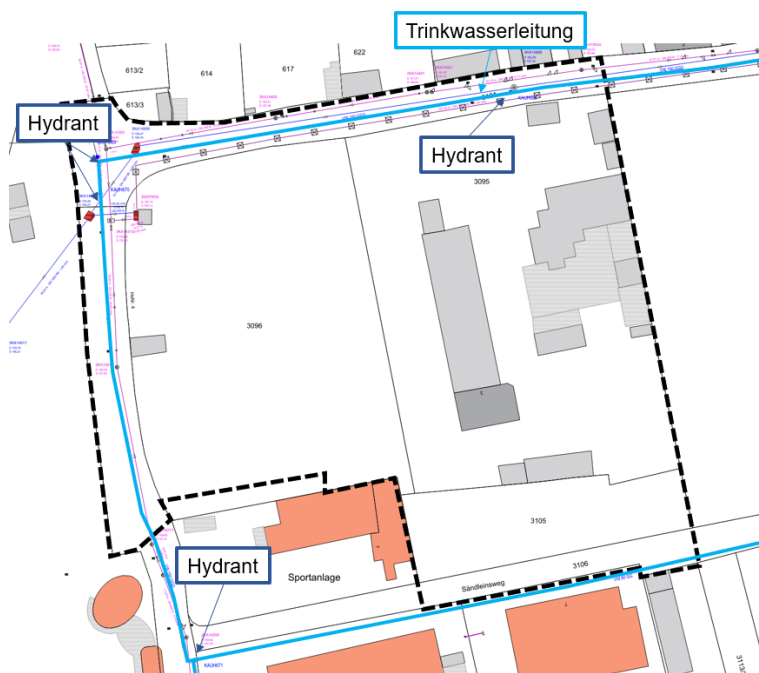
Lageplan örtliches Trinkwassernetz und Hydranten (Stadtwerke Karlstadt)
